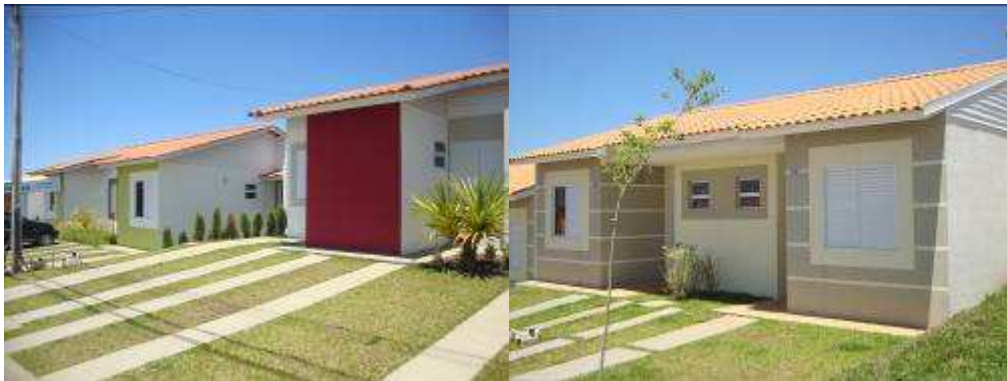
CASAS DE PAREDES DE CONCRETO MOLDADAS NO LOCAL
